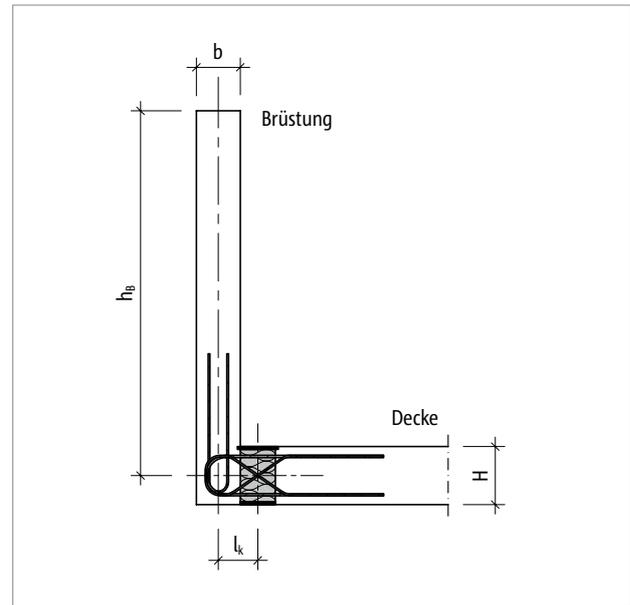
Schöck Isokorb® XT/T Typ F: Statisches System
